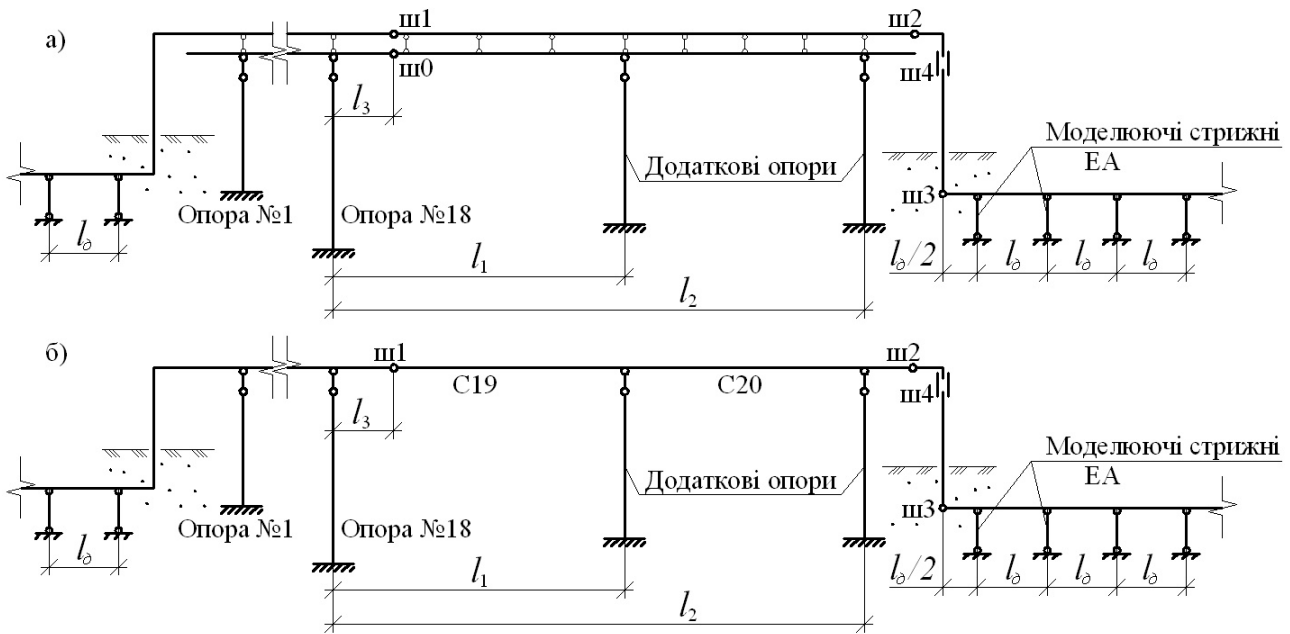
Розрахункові схеми переходу, що відповідають його стану 1 (прольоти між опорами № 1 та № 18 умовно не показані): а) нафтопроводу; б) газопроводу
